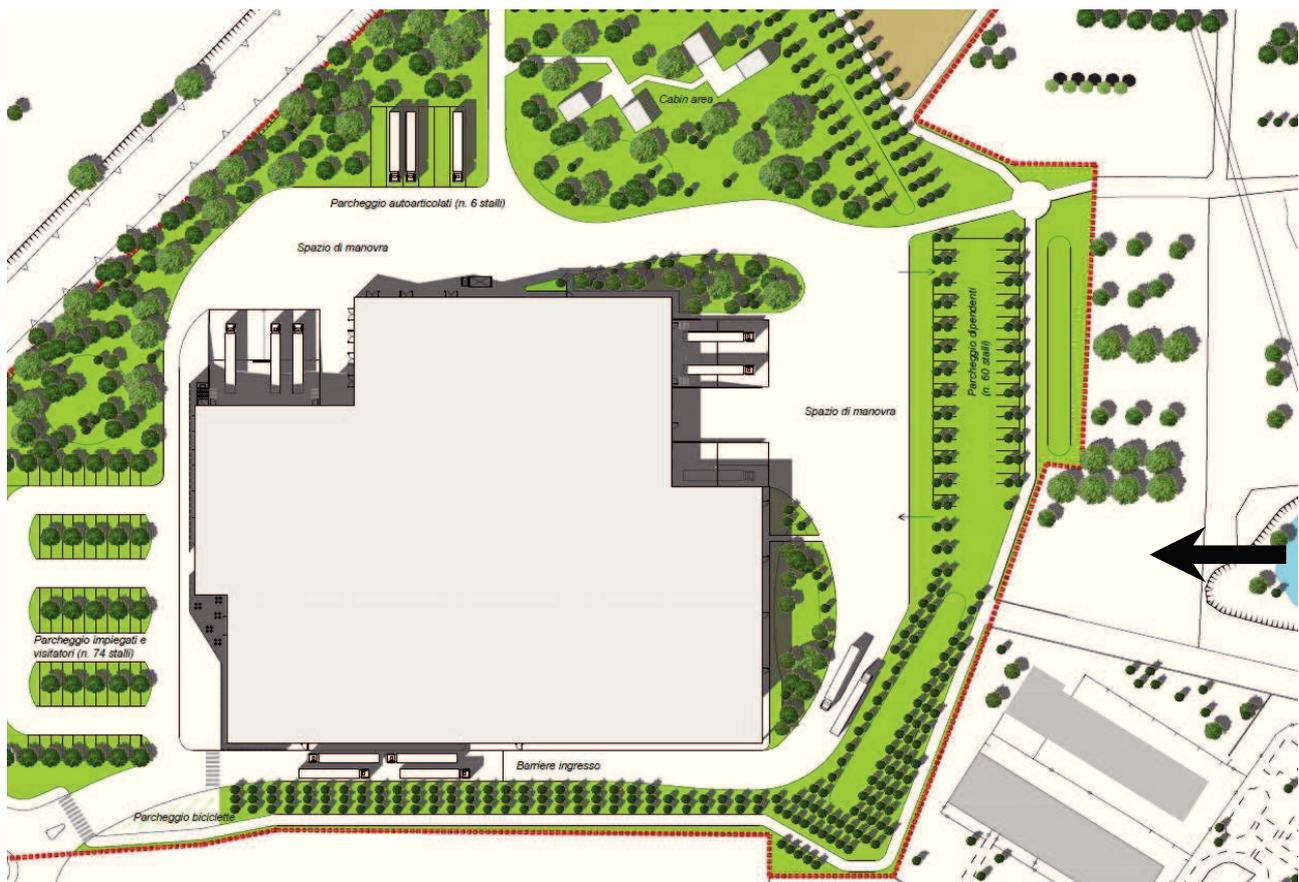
estratto layout di progetto con ubicazione stabilimento
